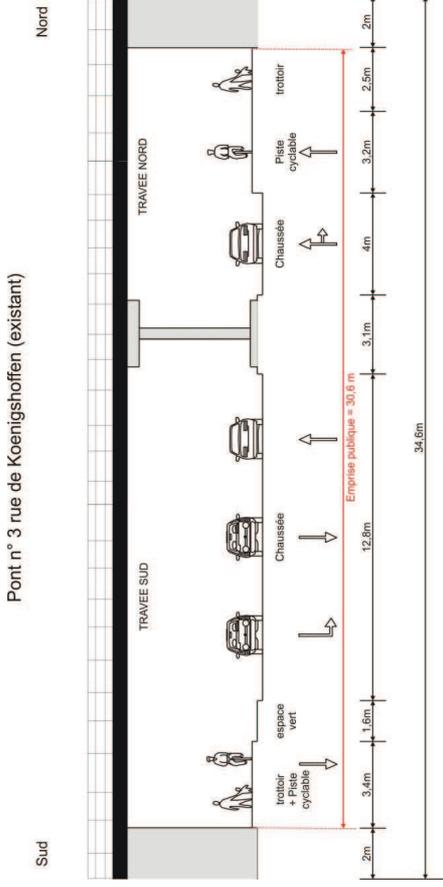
Situation initiale- coupe 33 – sur la rue de Koenigshoffen (pont 3)
